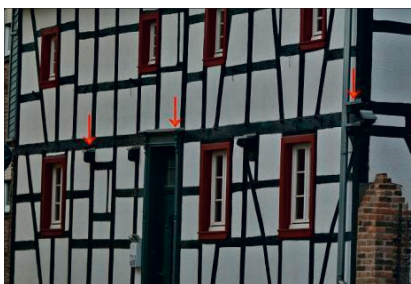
Kleine Details am Fachwerk, die der Wasserableitung dienen (Pfeile).
